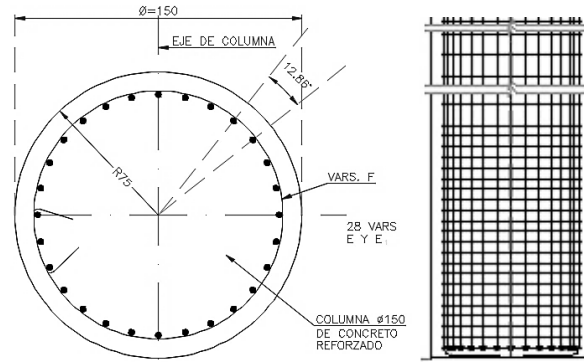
Dimensiones y armado de pila-columna en apoyo extremo.
